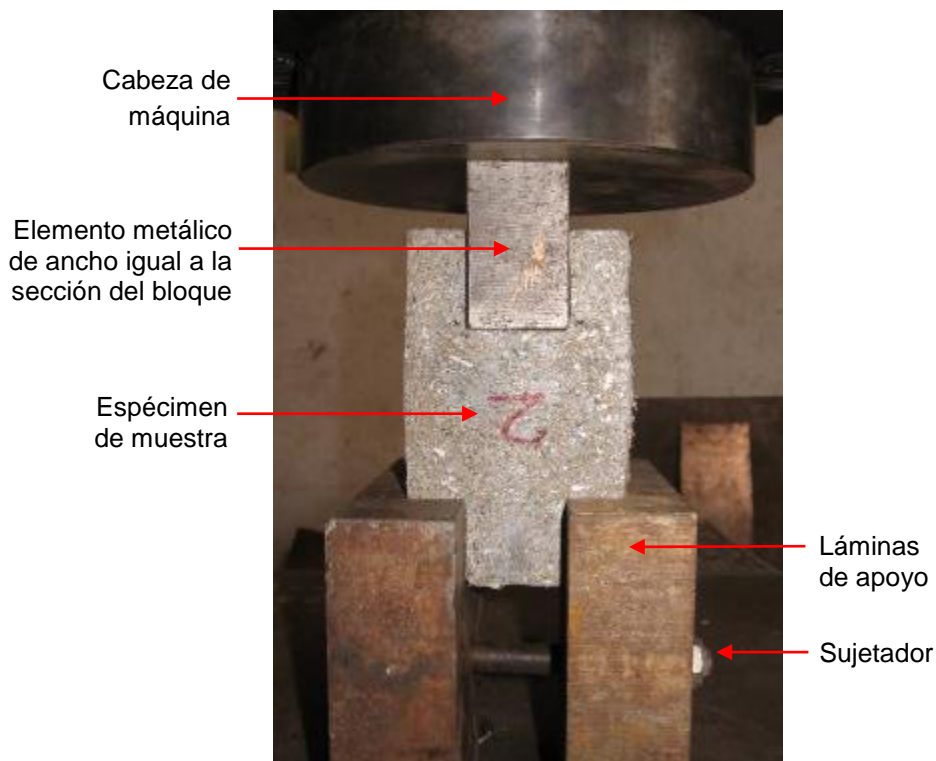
Montaje ensayo a cortante en sección de bloque. Fuente: Autor
